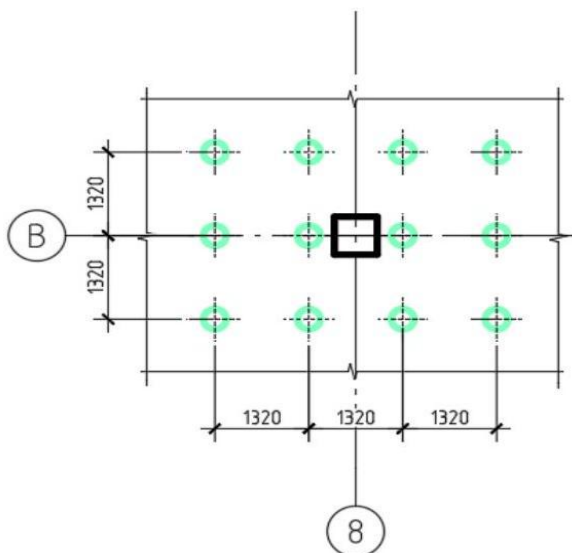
Схема розташування паль під фрагмент плитного фундаменту
